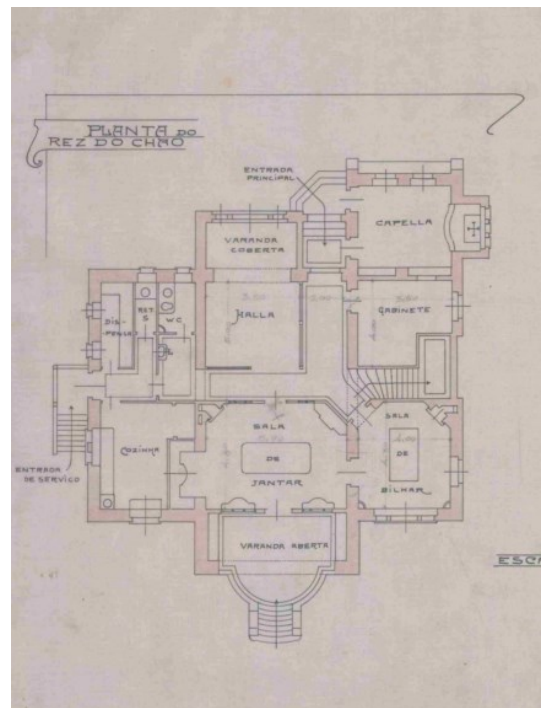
Planta da casa de campo de João Leal & Irmãos (1906)
